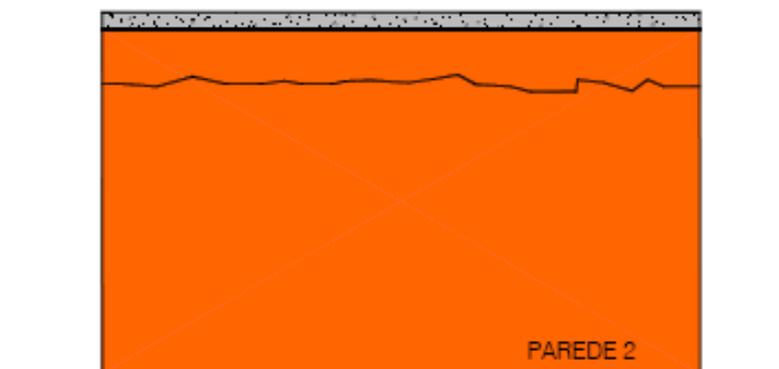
Fissura típica presente no topo da parede paralela ao comprimento da laje.
